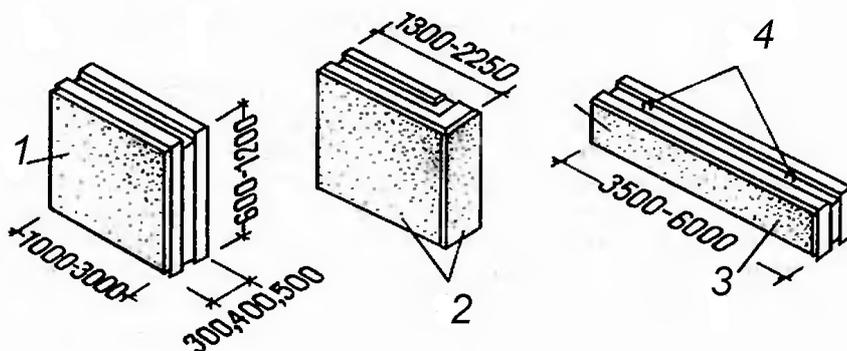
Типы крупных стеновых блоков из легкого бетона:
